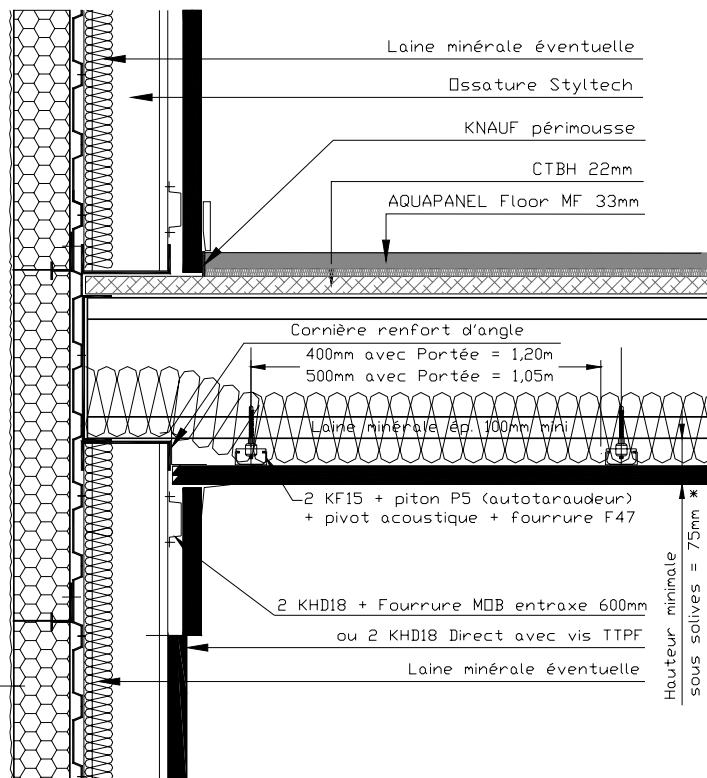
er – Coupe sur façade avec plafond Knauf Metal sur ossature F47
